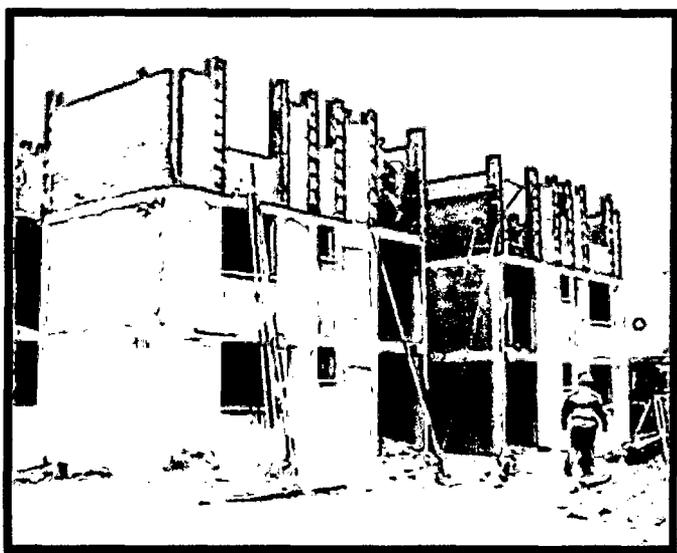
Proceso constructivo albañilería confinada (San Bartolomé 1994)
